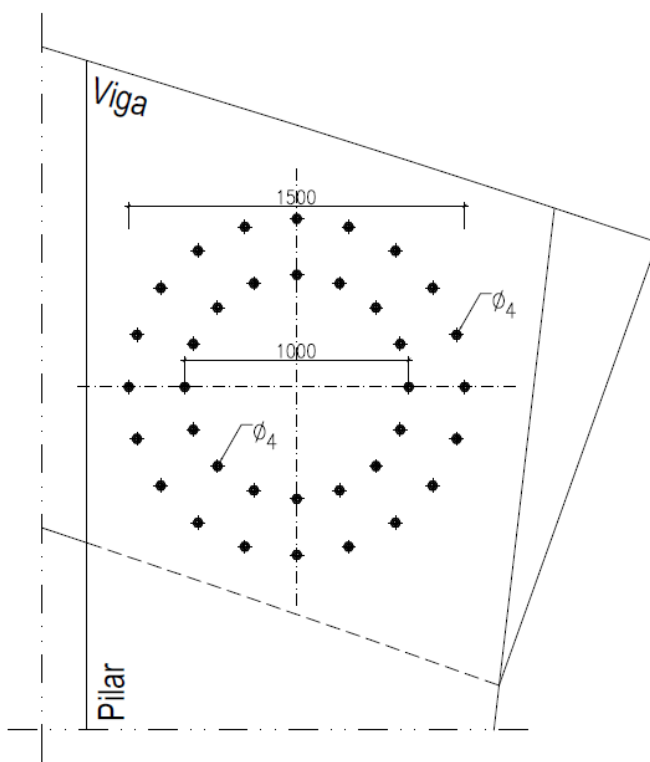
Esquema da ligação “pilar – viga” assumida para o Pavilhão Gimnodesportivo.
